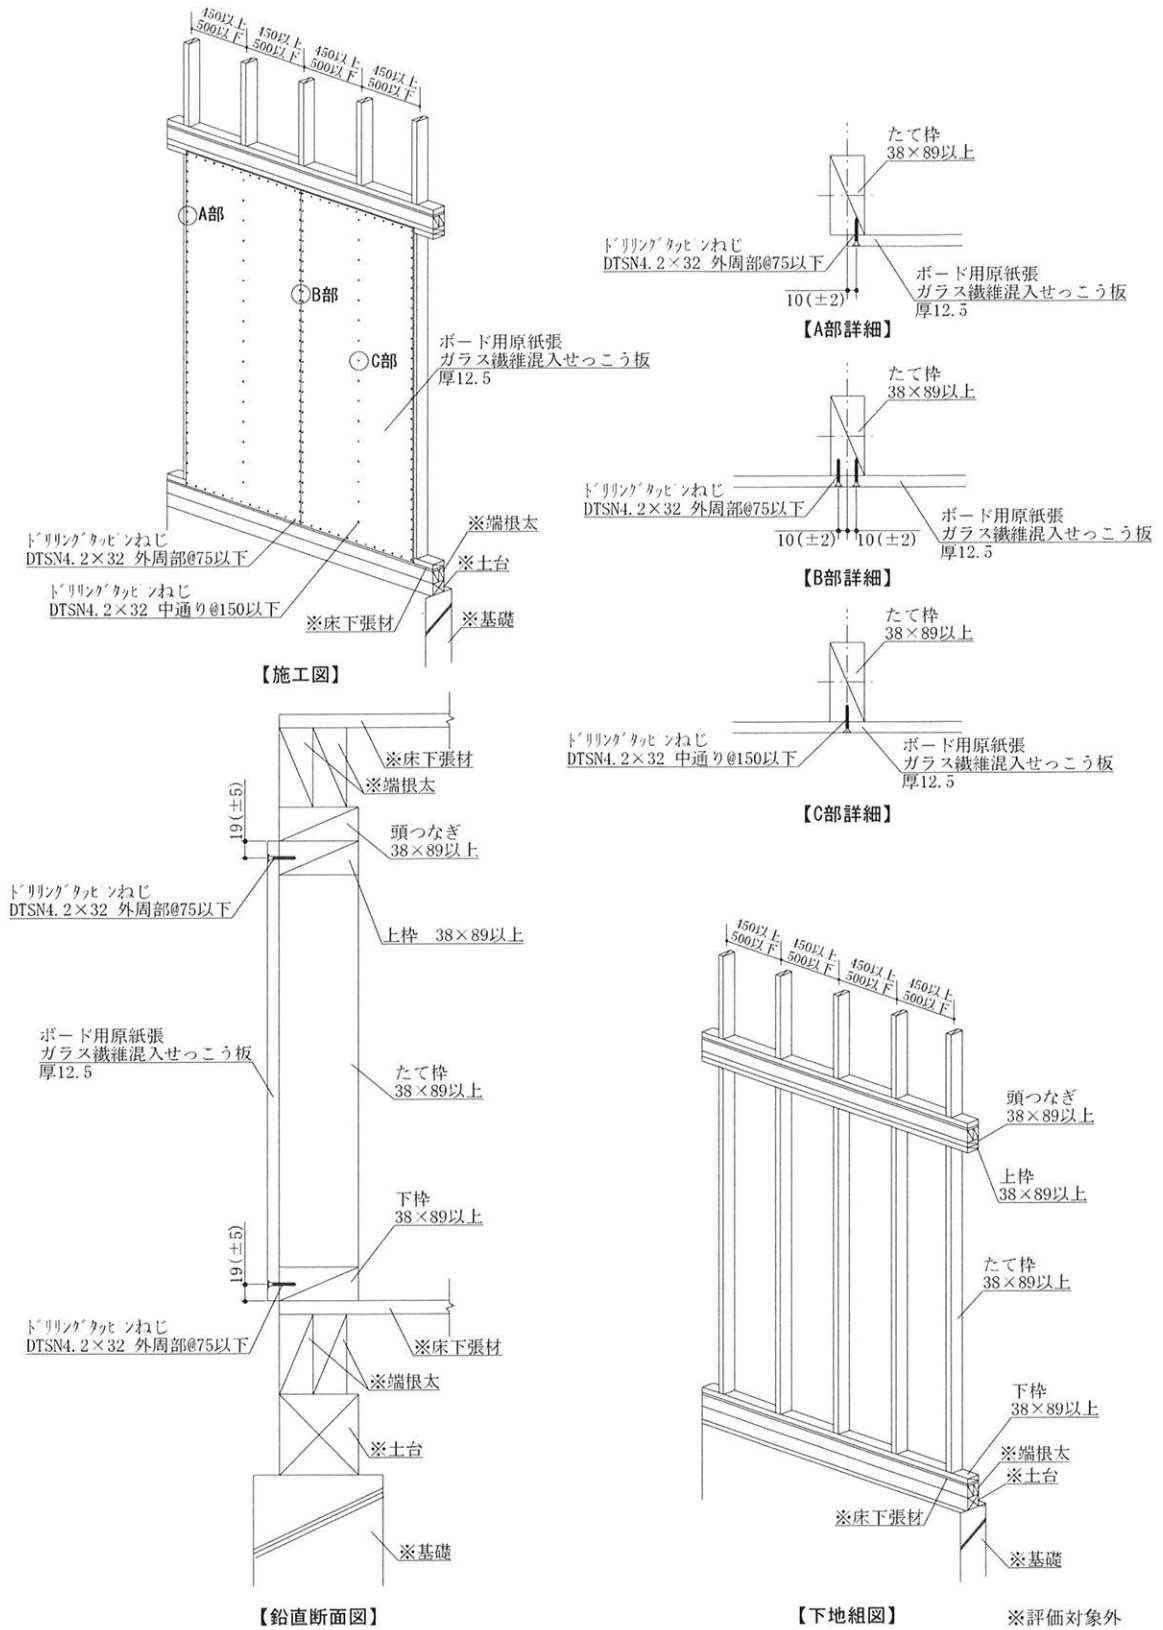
施工詳細図：1枚張りの場合 (寸法単位：mm)
